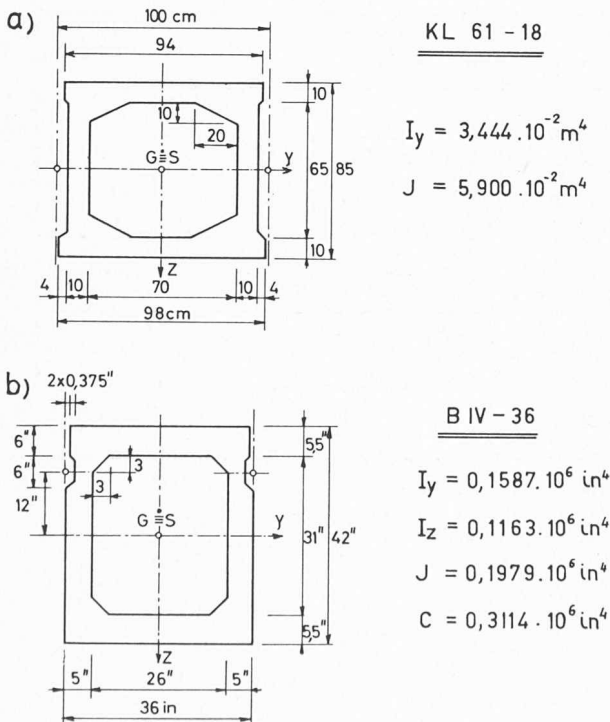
Quelques exemples réels de poutres-caissons préfabriquées.
